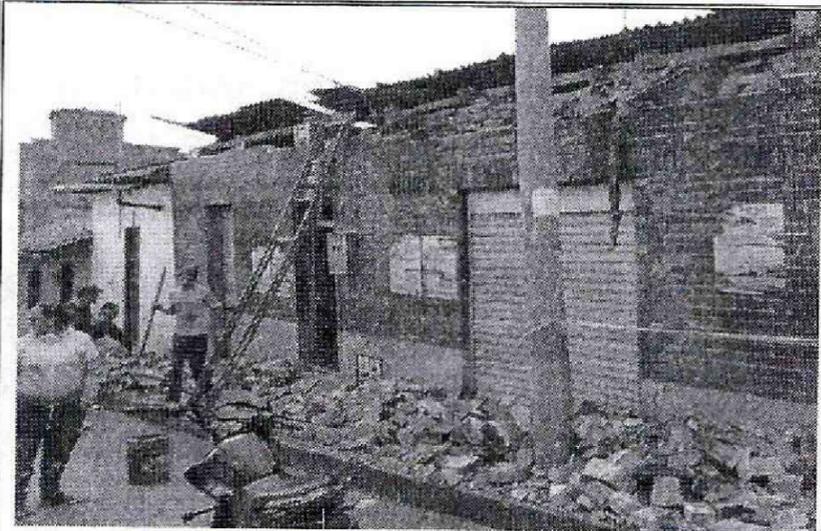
Retiro de material colapsado de la fachada de la vivienda, por personal que habita en la misma.
